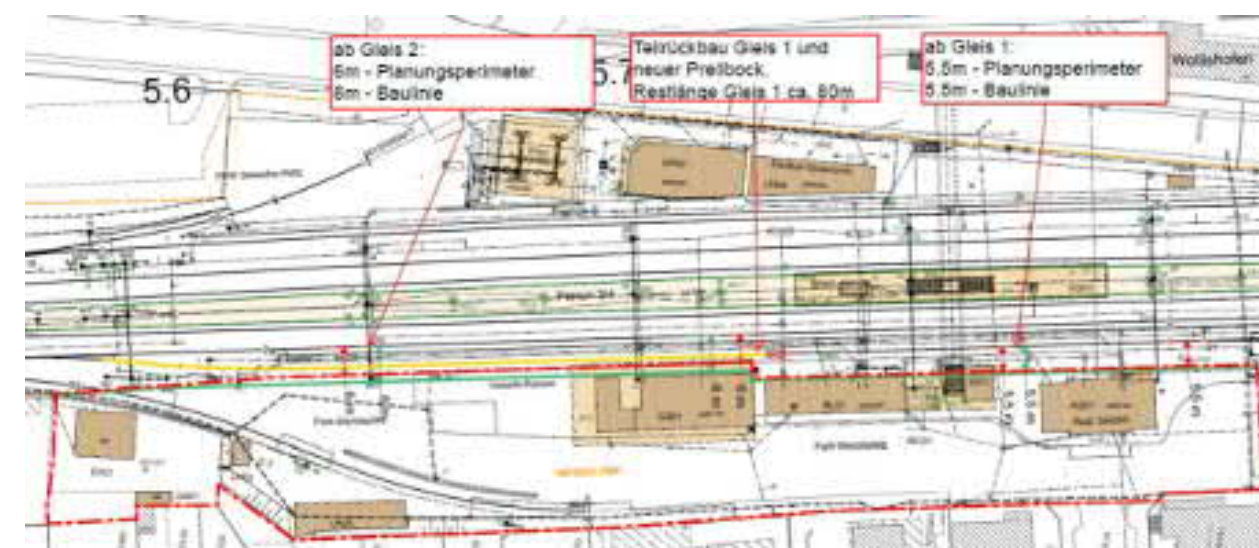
Planungssperimeter (rot) und Baulinie (grün)
